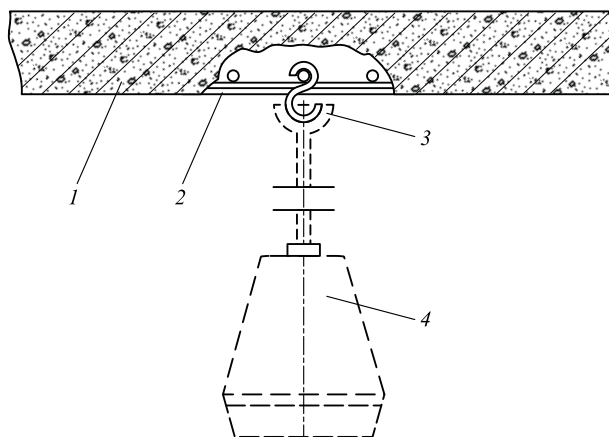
Установка крюка приваркой к арматуре перекрытия:
